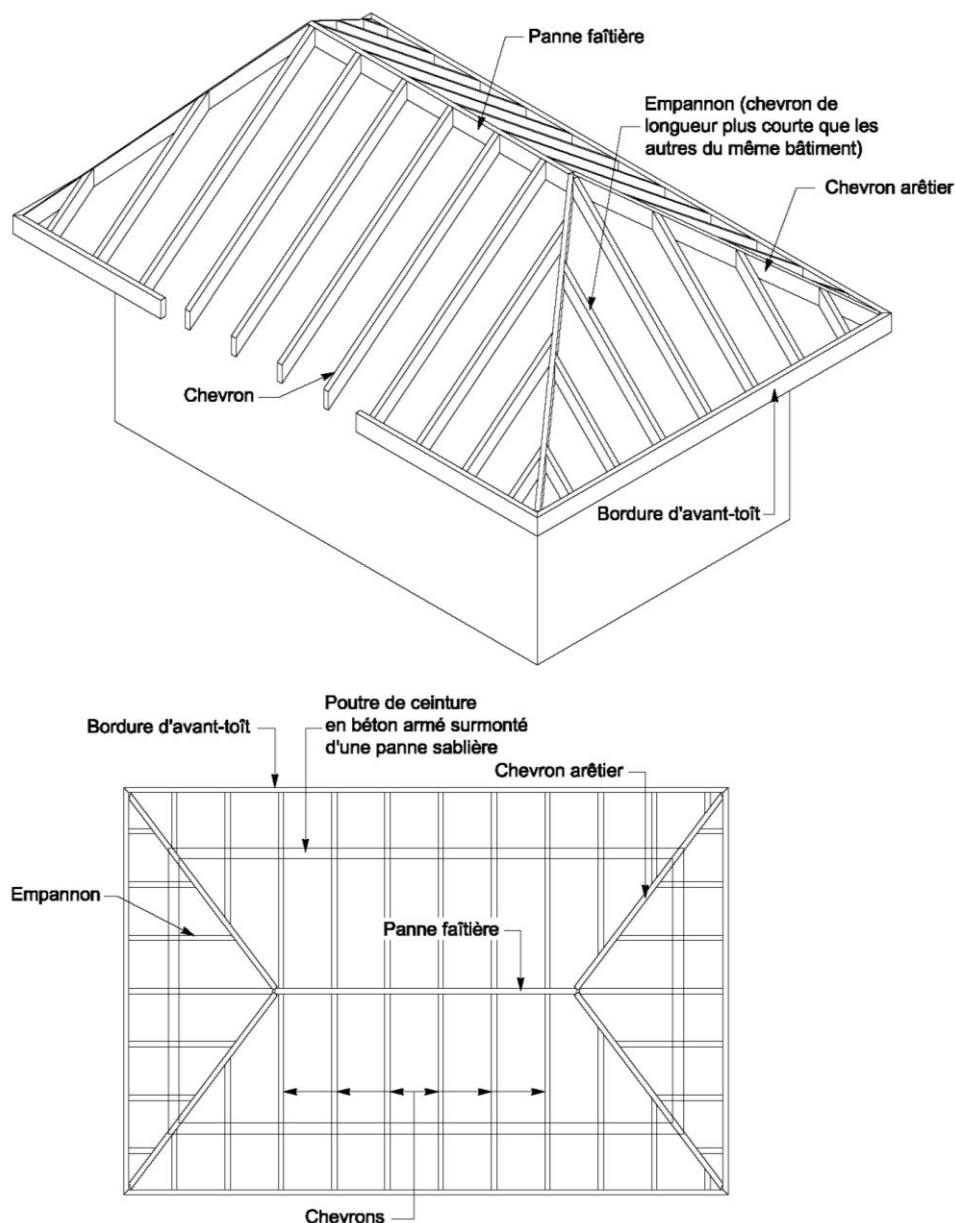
Détails de construction d'un toit en croupe (quatre pentes)
